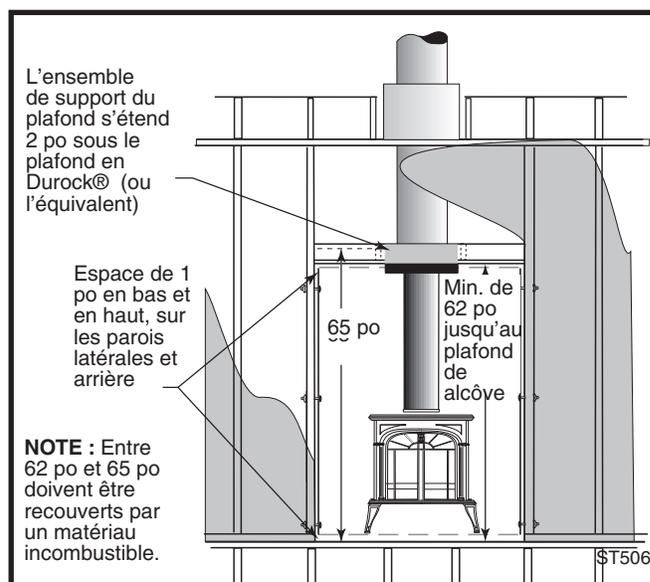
Section avant; dégagement minimal de 65 po entre la surface finie du plancher et les matériaux combustibles de la face avant. Le revêtement combustible peut recouvrir les montants métalliques sur 1 po seulement. Il ne doit pas aller sous la hauteur du plafond incombustible.
